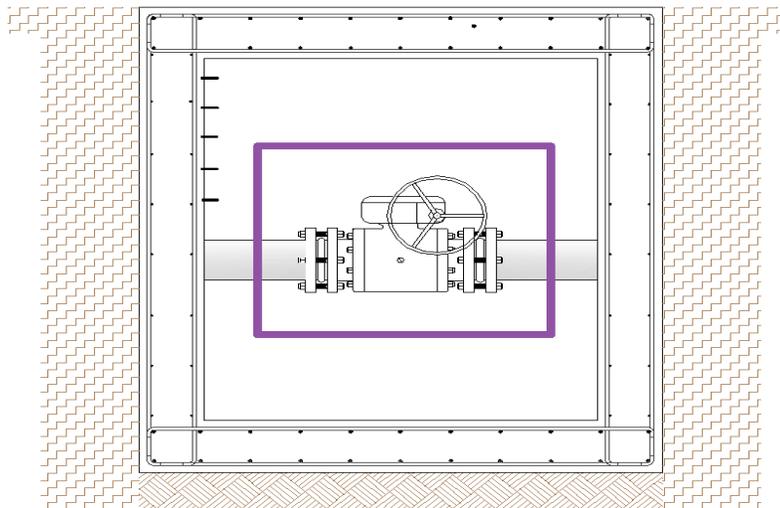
(vista de perfil) Interior de cámara. Estribos y ducto de ventilación.
